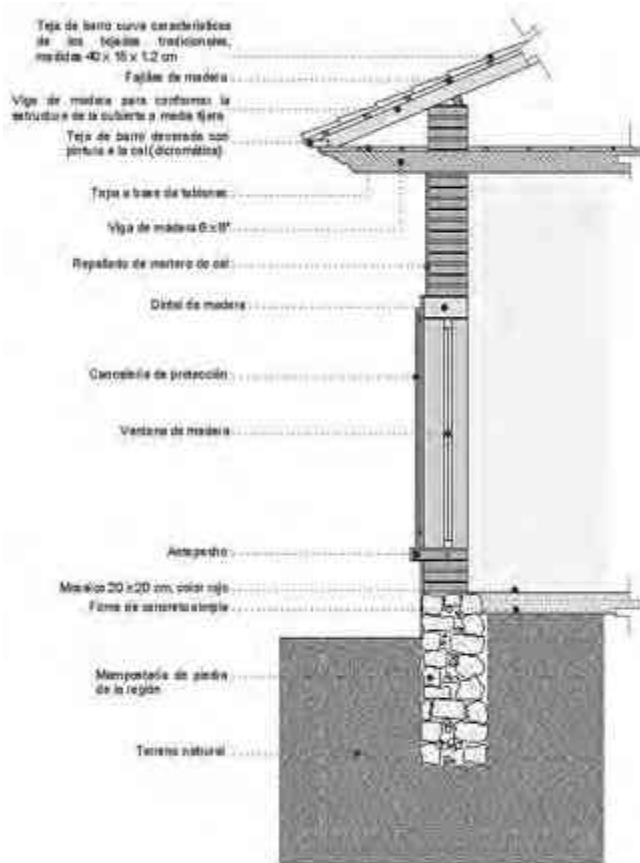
Corte por fachada de la vivienda Fajardo. Fuente: J. J. Segura Granados.
